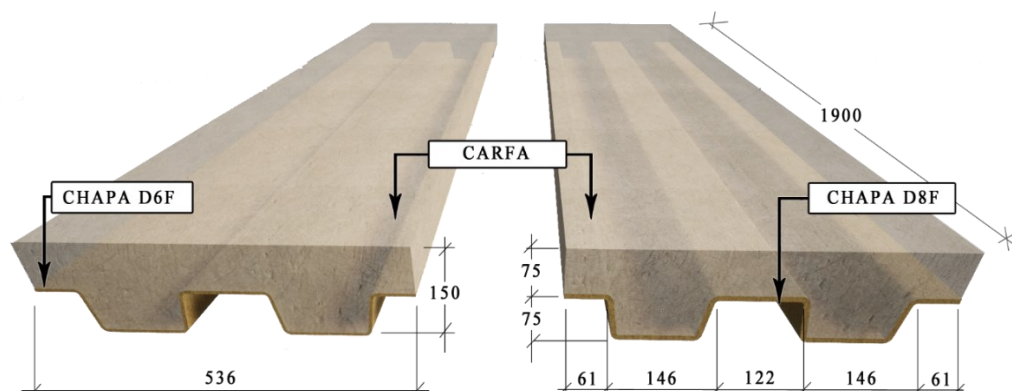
Geometria das lajes ensaiadas (medidas em milímetros).
